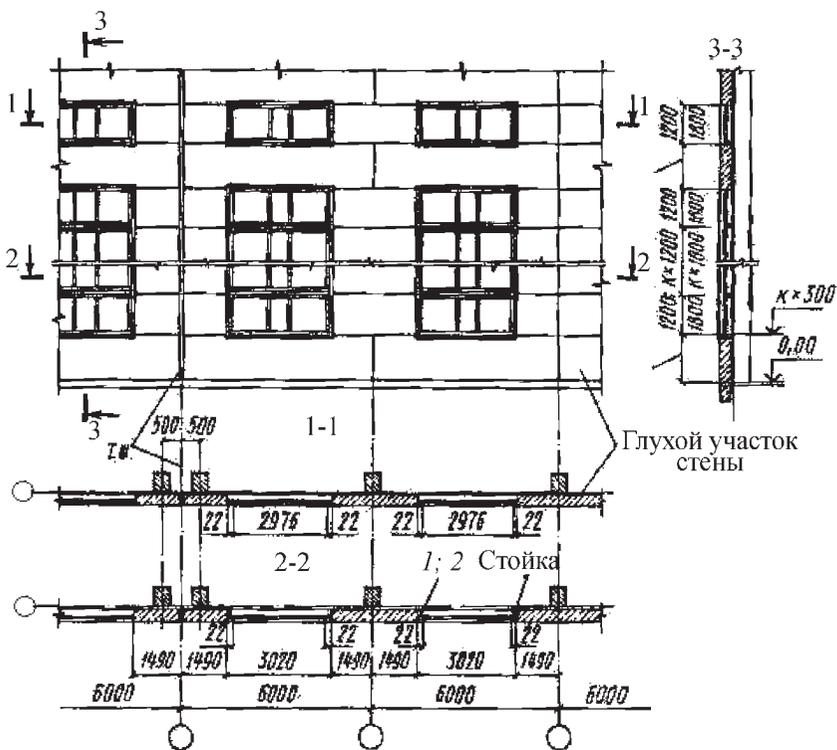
Фрагмент фасада здания (стены из легкобетонных панелей)
